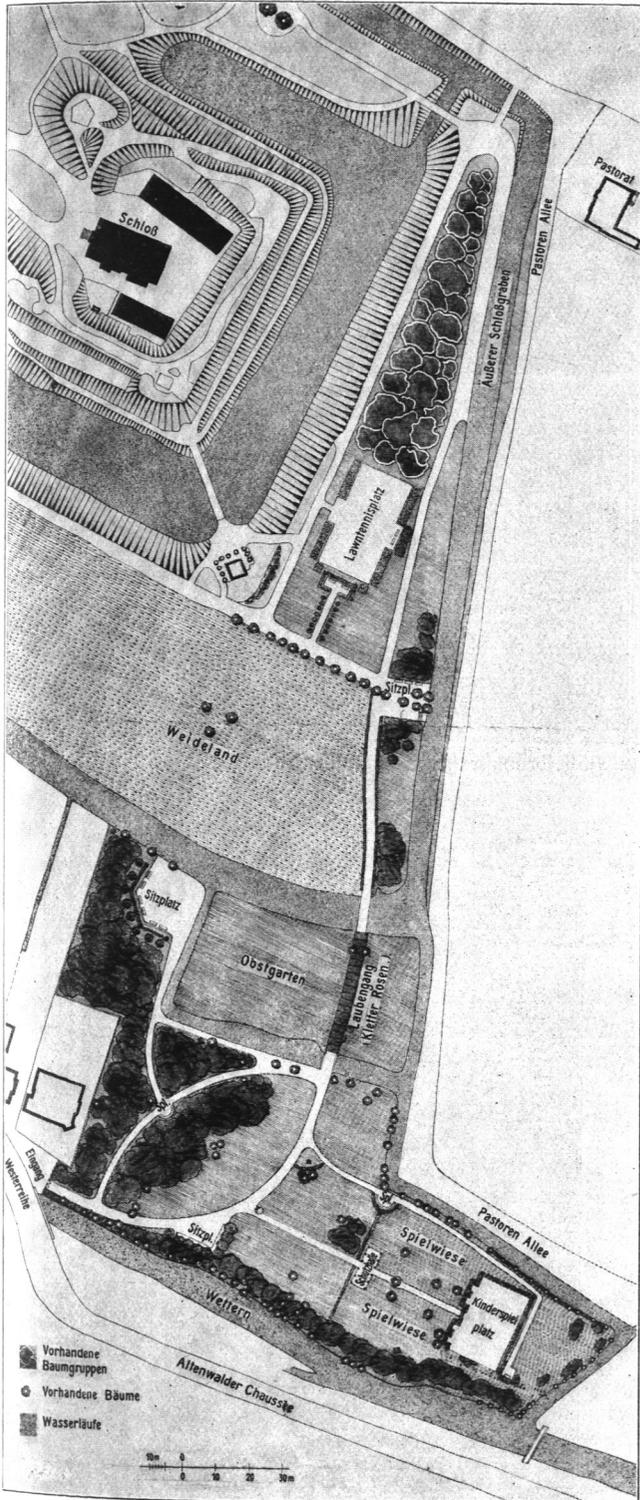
Rixbütteler Schlossgarten in Cuxhaven, Lageplan.
